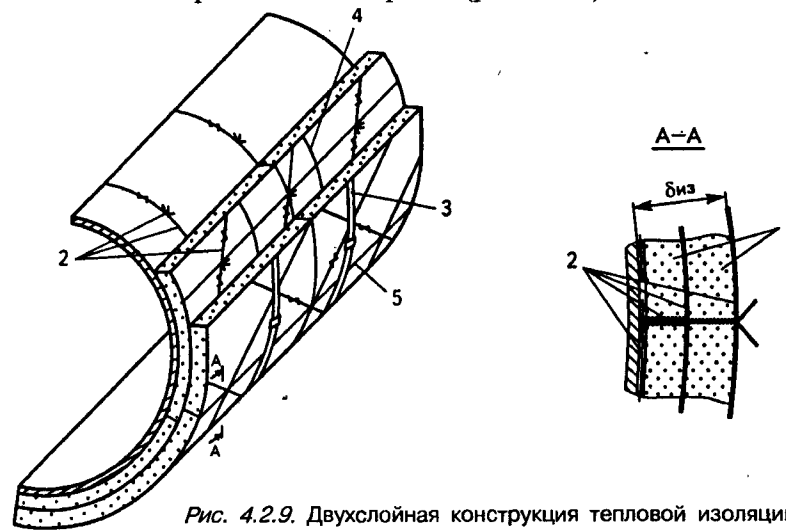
Двухслойная конструкция тепловой изоляции горизонтального аппарата с креплением теплоизоляционного слоя на проволоочном каркасе:
